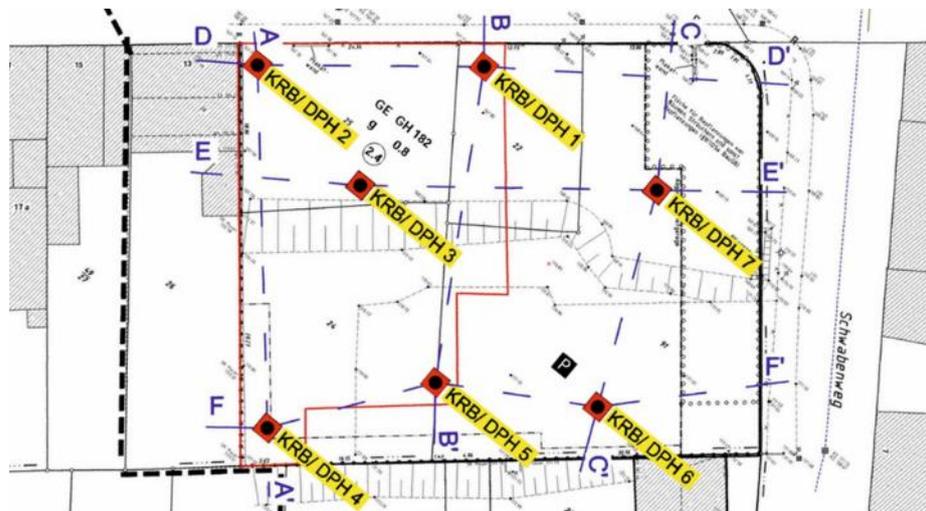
Auszug aus dem Lageplan zum geotechnischen Bericht mit Darstellung der Kleinrammbohrungen¹⁶
